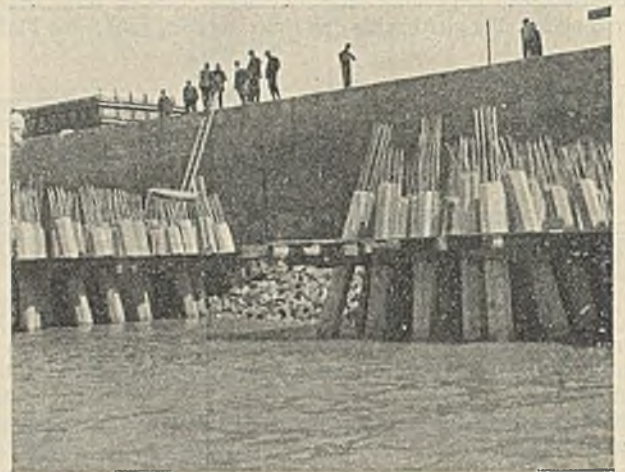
Der Arbeitsboden ist an den Eisenbetonpfählen mittels darunterliegender Klammern befestigt.
